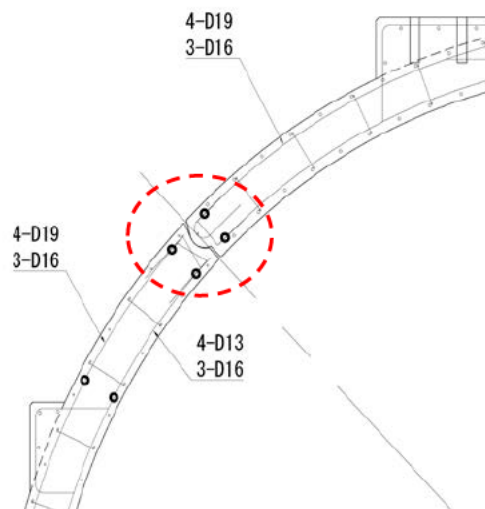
ヒンジ付近の鉄筋ゲージ位置
